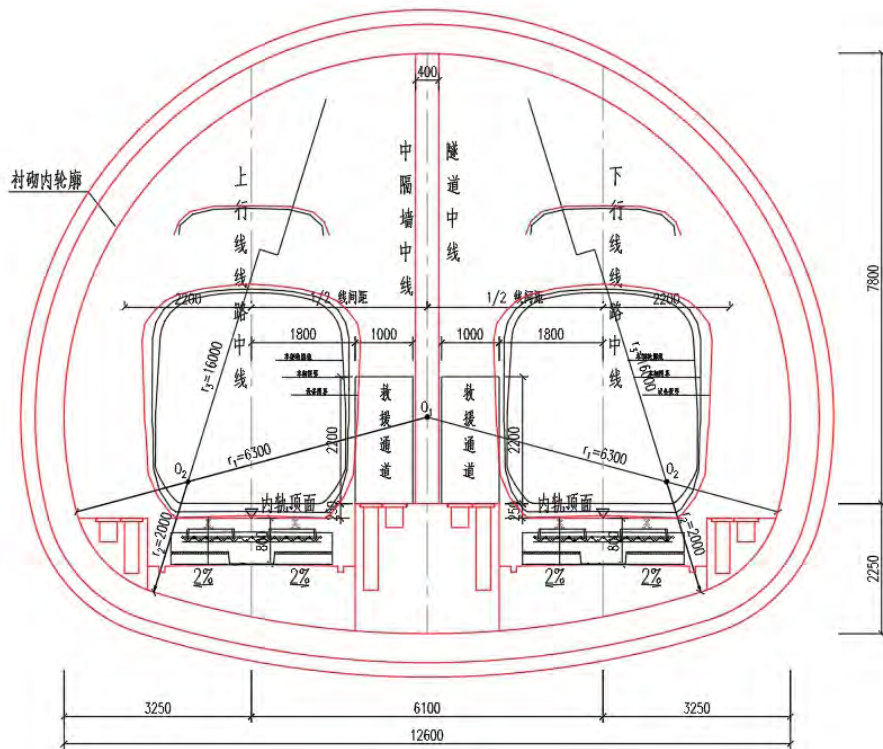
单洞双线矿山法隧道横断面图（带中隔墙）
